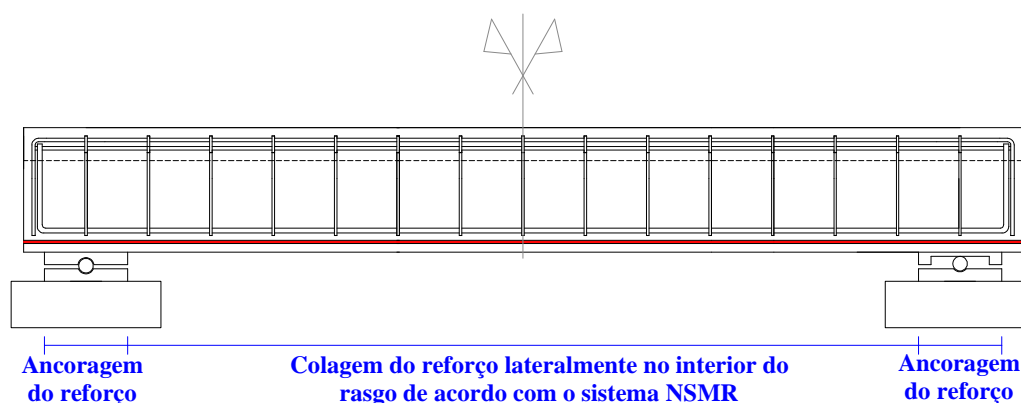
Sistema de ancoragem do material de reforço ao elemento estrutural
